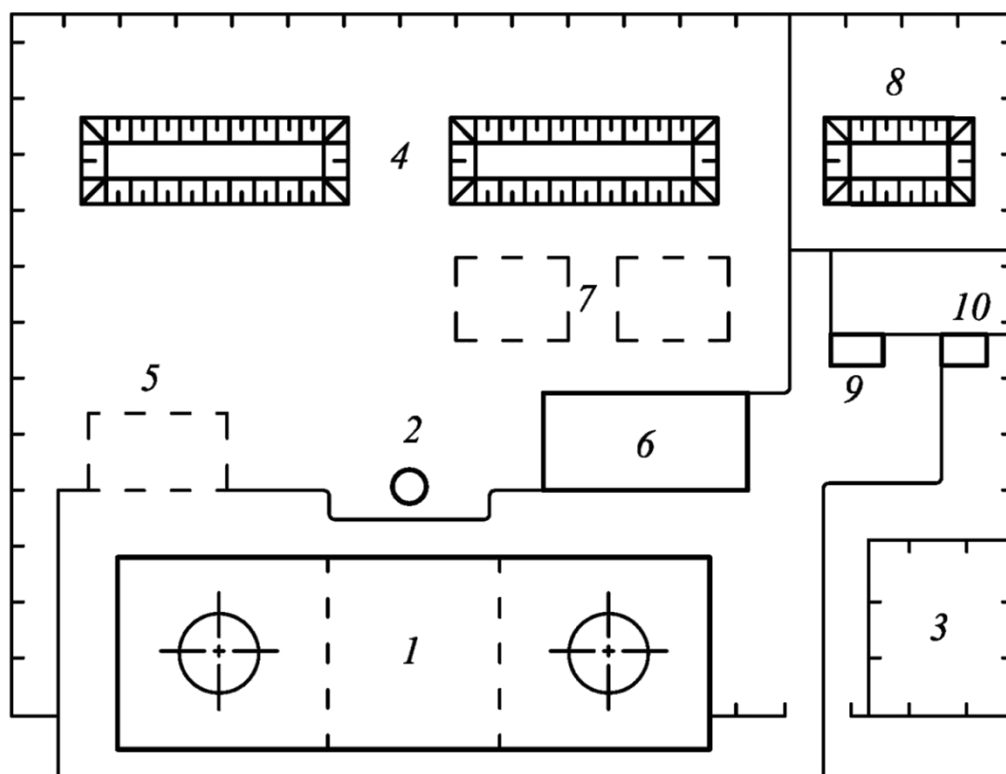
Схема генерального плана атомной станции теплоснабжения:
